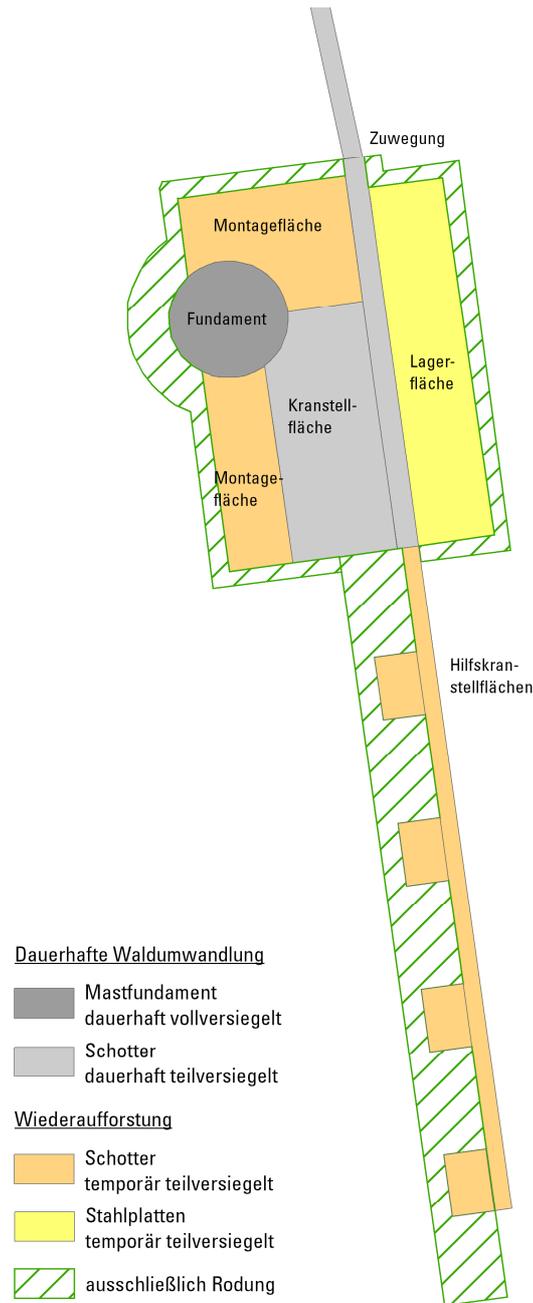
Beispielhafter Lageplan einer WEA des Typs E160 EP5 E2 im Wald mit dauerhaft und temporär beanspruchten Flächen.
